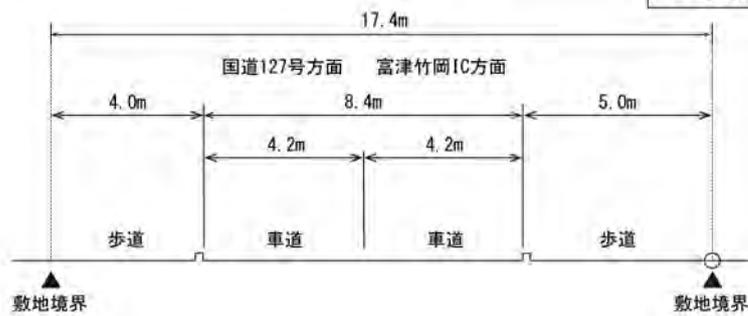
(6) 予測断面図 (F 県道 91 号竹岡インター線)
